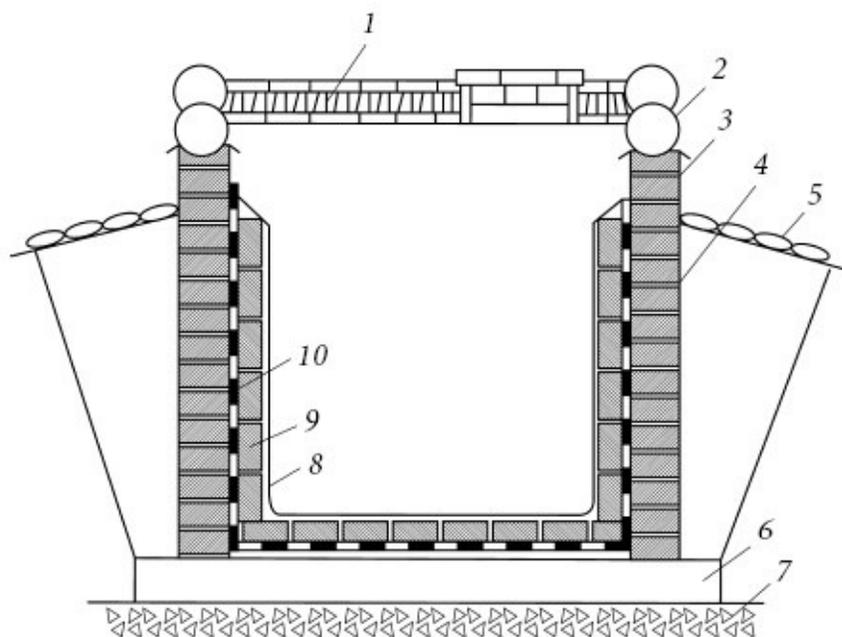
Устройство противонапорной гидроизоляции со стороны погреба: 1) перекрытие; 2) деревянный сруб; 3) кирпичная стена; 4) обмазка битумной мастикой; 5) засыпка пазух; 6) бетонное основание; 7) подготовка из утрамбованного щебня; 8) оклеечная противонапорная гидроизоляция; 9) защитная стенка; 10) цементная штукатурка
